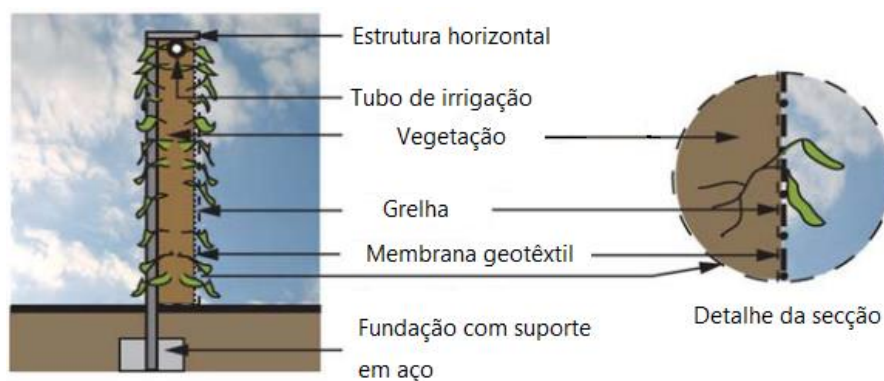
Esquema de bio-barreira estilo caixa de solo ou *box wall* (adaptado de Kotzen & English, 2009)
